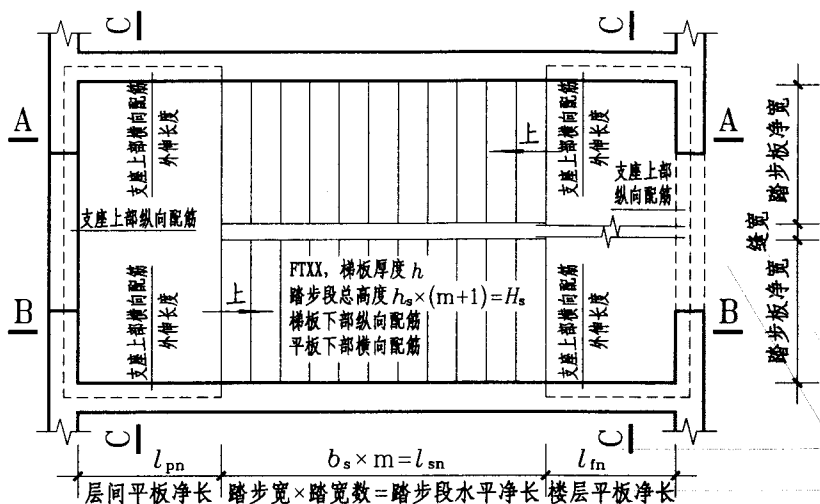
注写方式 标高XXX—标高XXX楼梯平面图
